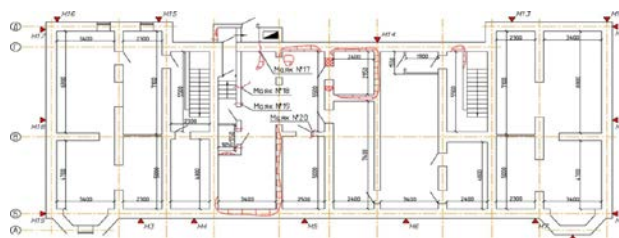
План типового этажа пятиэтажного жилого дома со схемой установки осадочных марок 1-25.
